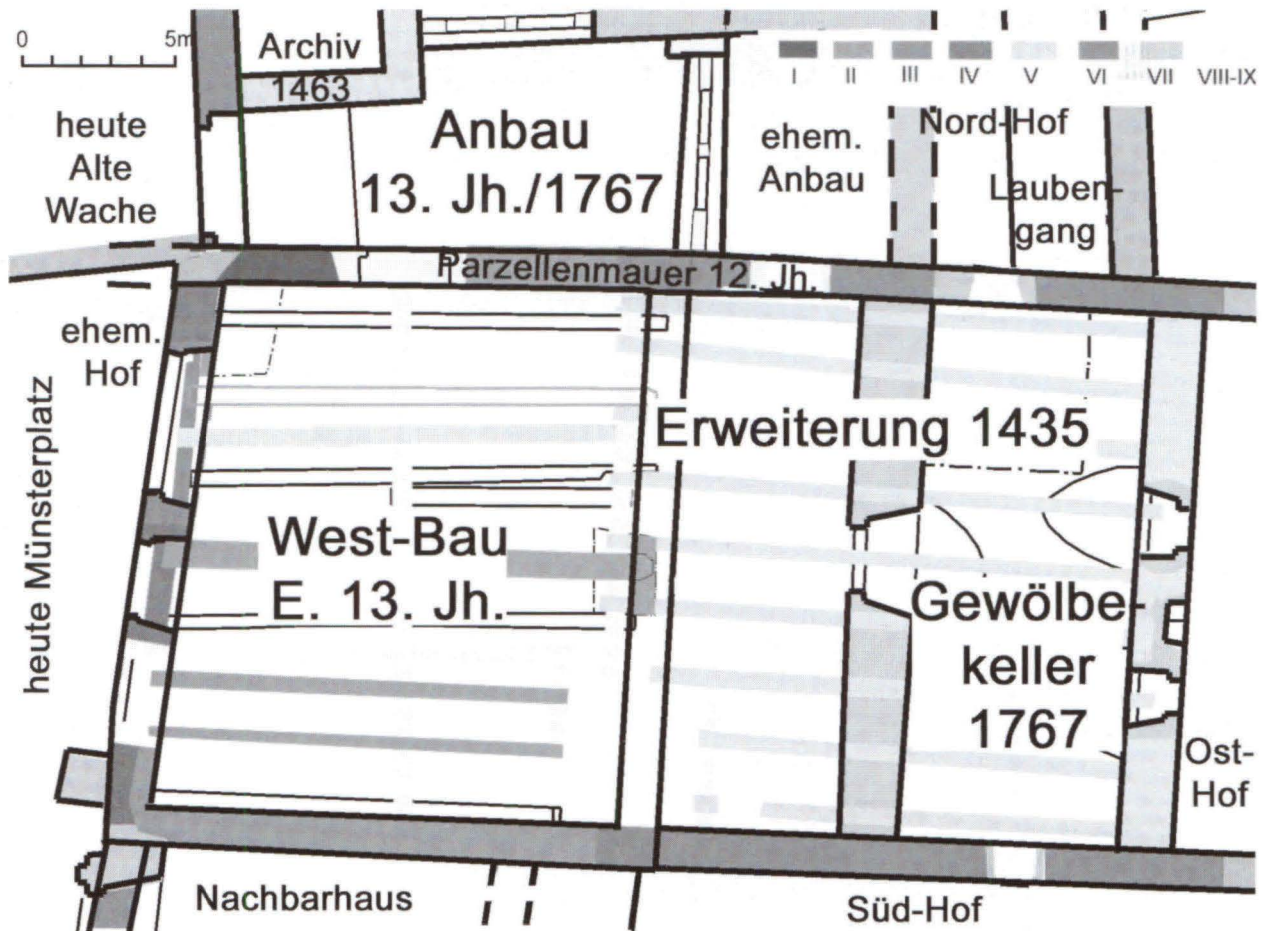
Grundriss des Erdgeschosses mit Eintragung der Bauphasen (Autoren)
